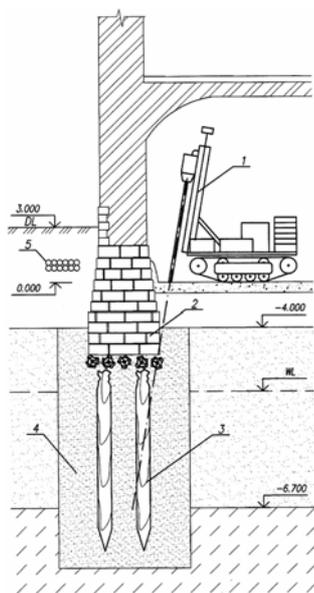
Усиление фундаментов исторического здания в Вене по струйной технологии: 1 – буровой станок; 2 – бутовый фундамент; 3 – деревянные сваи; 4 – закрепленный грунт; 5 – инженерные сети
